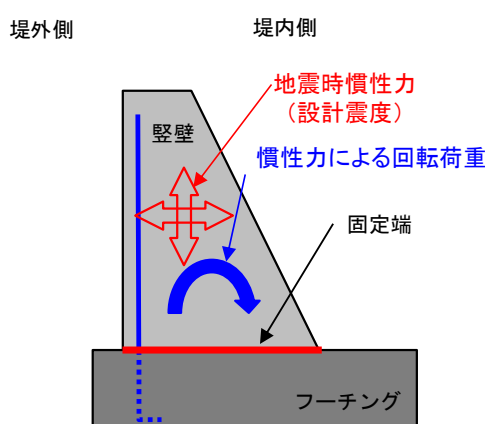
鉄筋コンクリート防潮壁の評価モデル概念図
